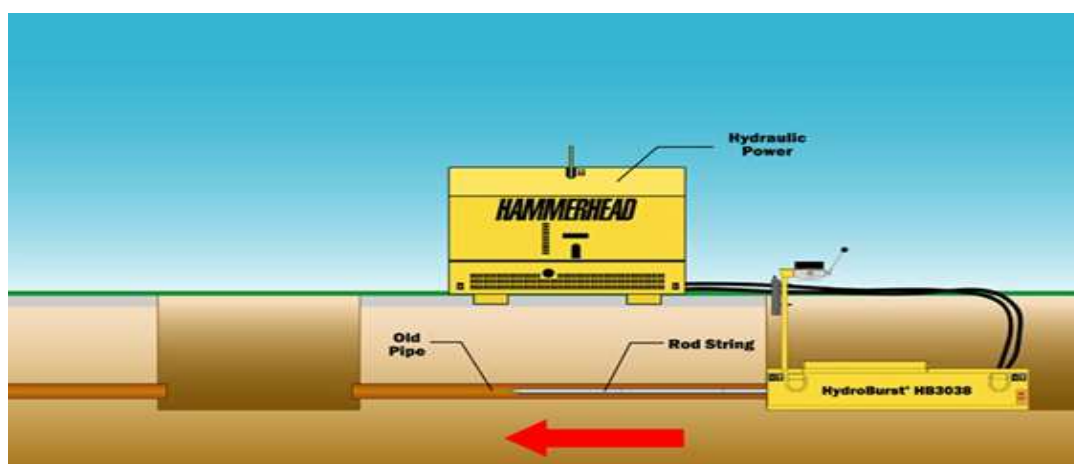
Схема работы оборудования Hammerhead HB 80
